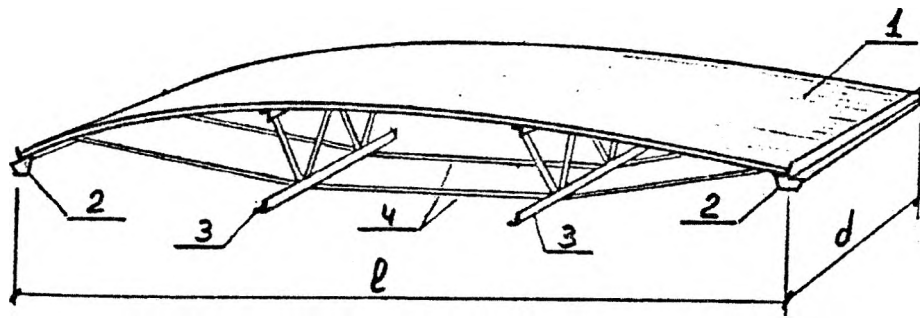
Общий вид панели-оболочки: 1 – пролётная конструкция; 2 – опорные элементы; 3 – решётчатые стойки; 4 – затяжки
